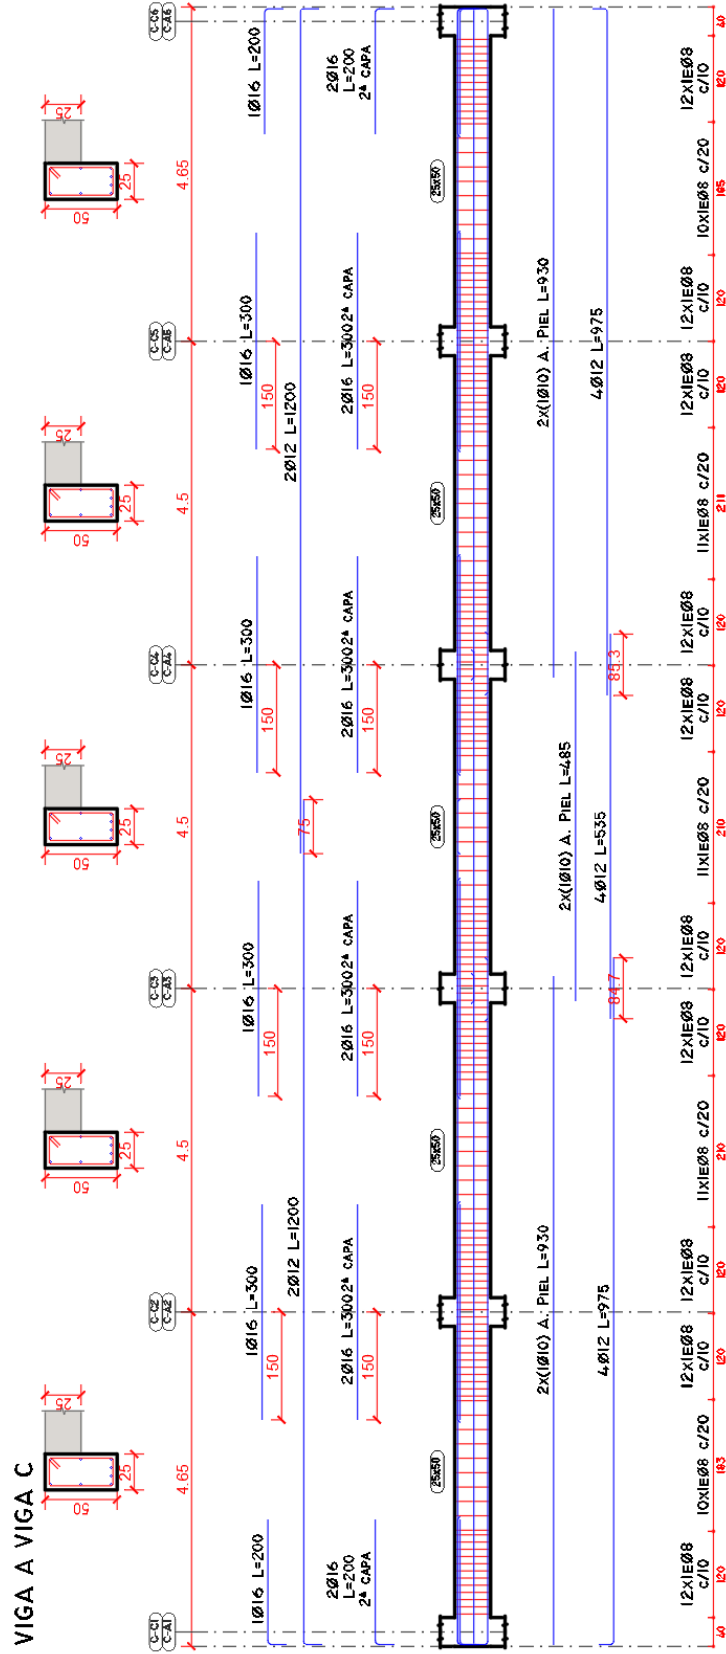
Detalle de Refuerzo Vigas en "Y" Losa 5 a 7 Estructura [7N-EE].
